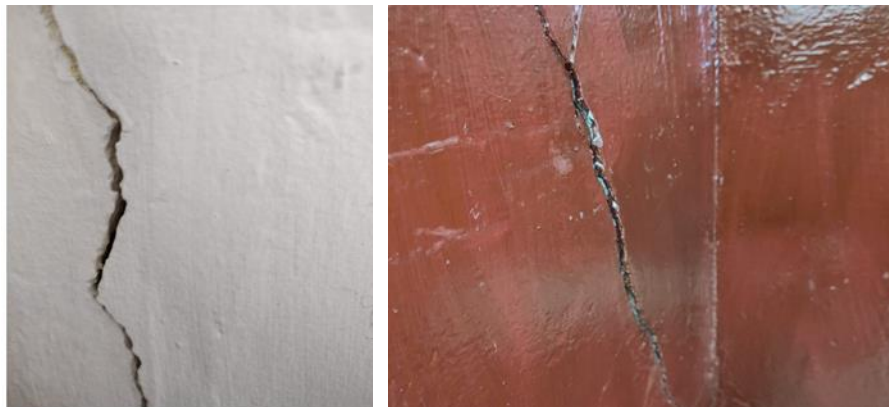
Grietas pintadas internamente, Fuente: Propia.
